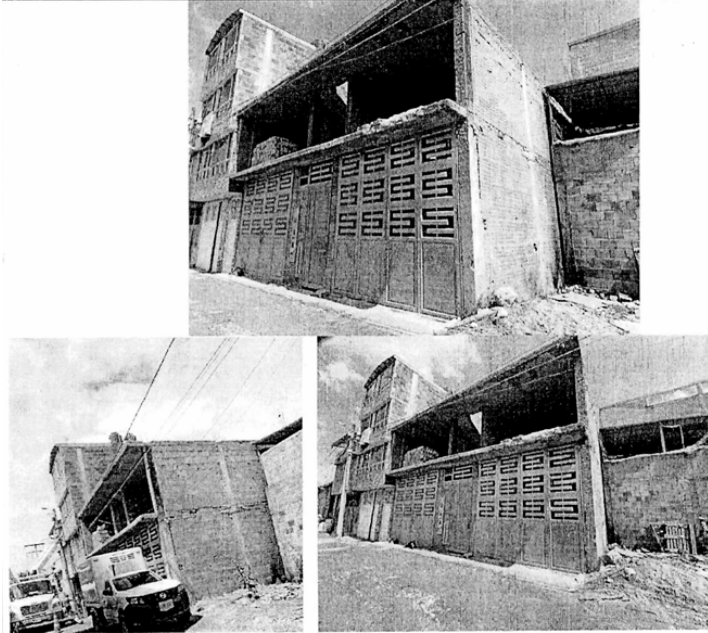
Informe Técnico PG410-2023 (folio 97)
